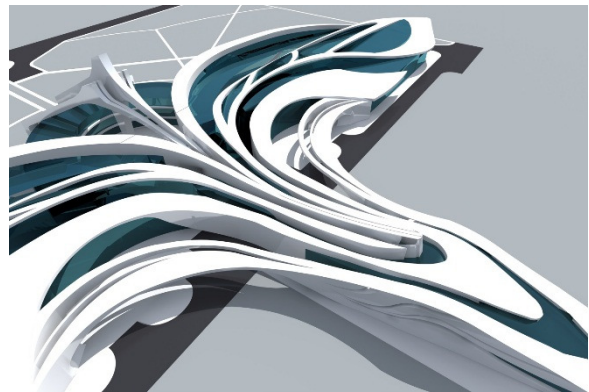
Фрагмент блока для размещения установки термической переработки и плазменного сжигателя
